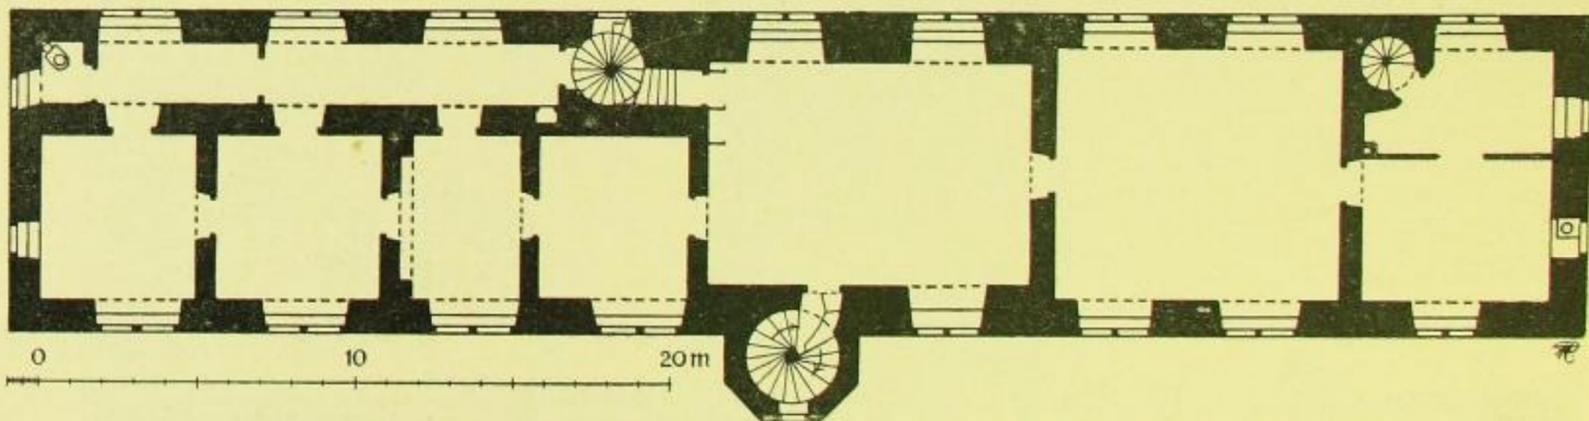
Zottewitz, Schloß, Grundriß des 1. Obergeschosses.
